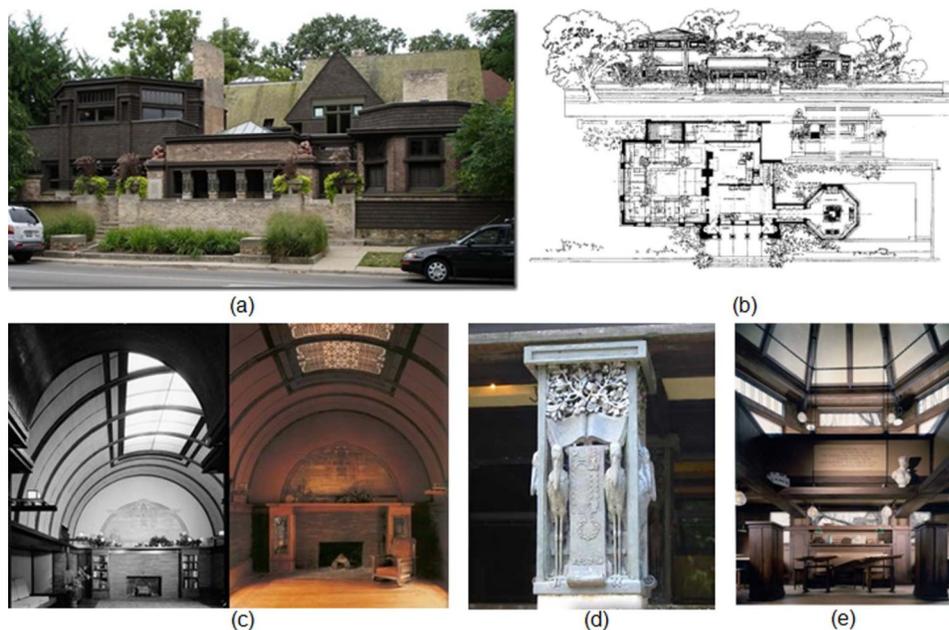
Casa-Estudio Frank Lloyd Wright, Oak Park, Chicago, E.U.A., (1890): (a) Vista exterior, (b) Elevación y planta arquitectónica, (c) Salón de juegos en su estado original y tras su restauración, (d) Detalle de la columna con capitel en forma de cigüeña, (e) Detalle interior, sala de estudio.
